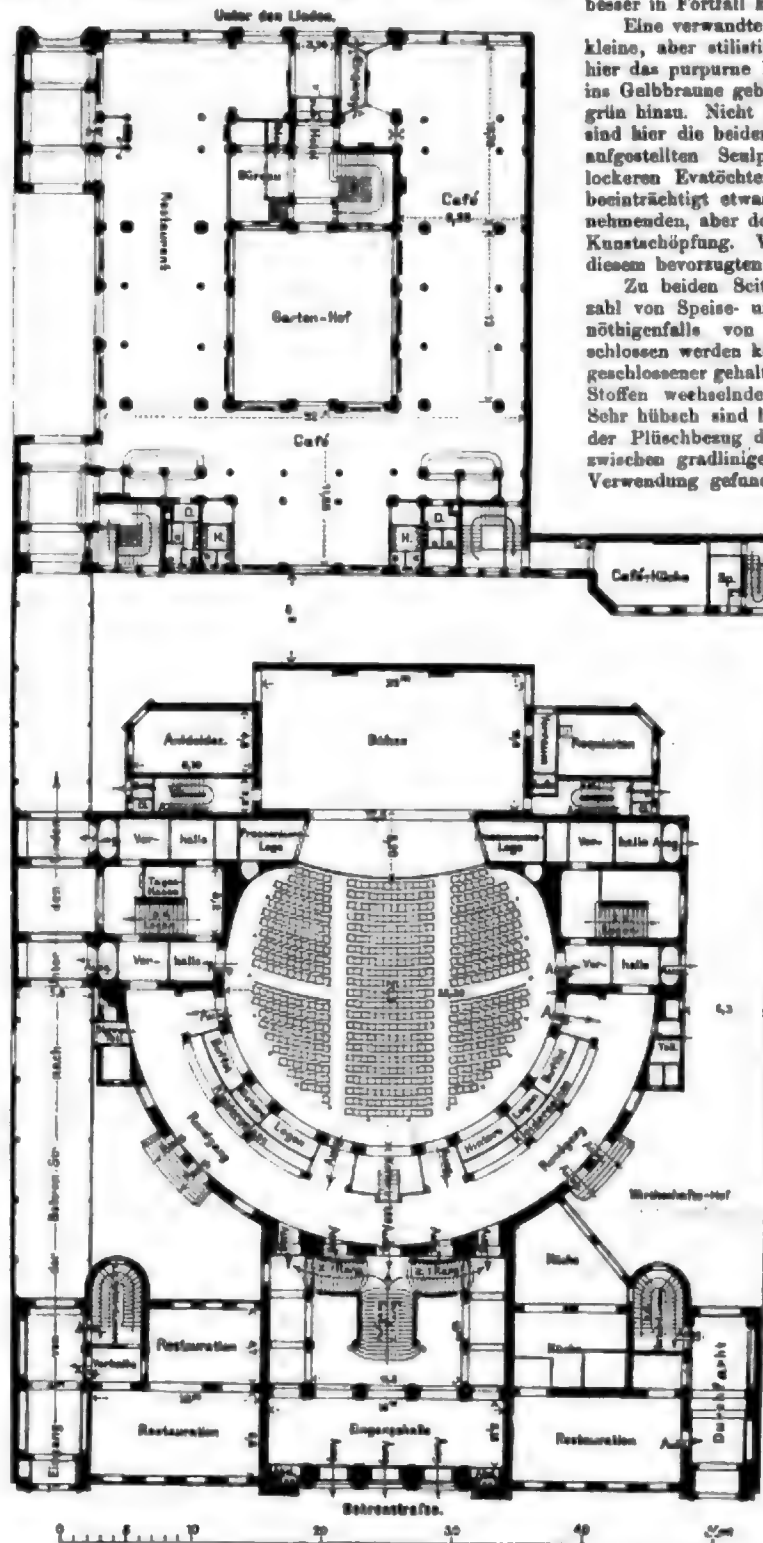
Erdgeschossgrundriß der Gesamtanlage.
